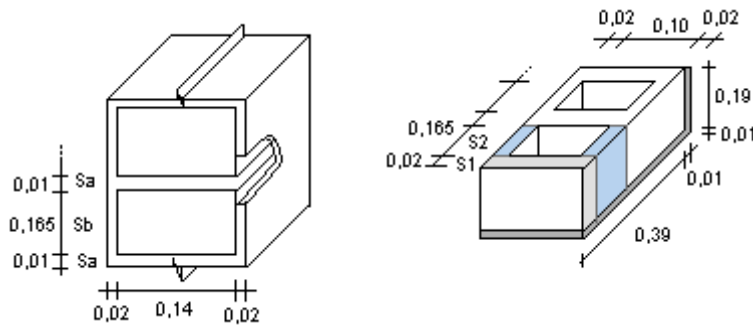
Desenho esquemático do bloco de concreto constituinte da parede da Fundação e a orientação da transferência de calor com o ambiente externo.
